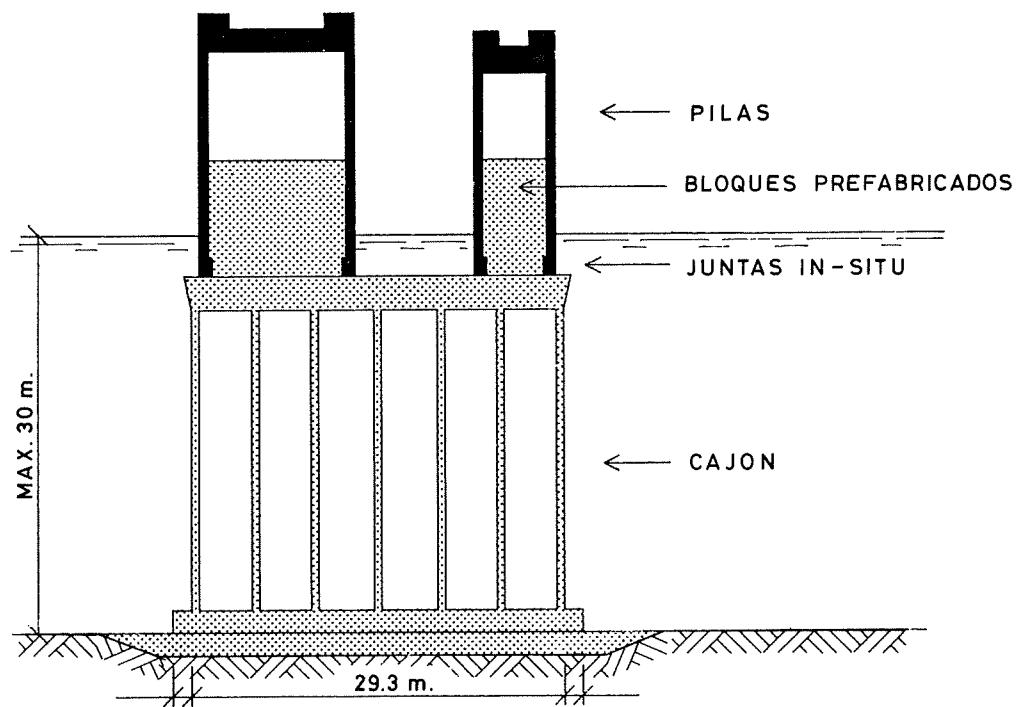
Cajones y pilas en cajón prefabricado de hormigón.
